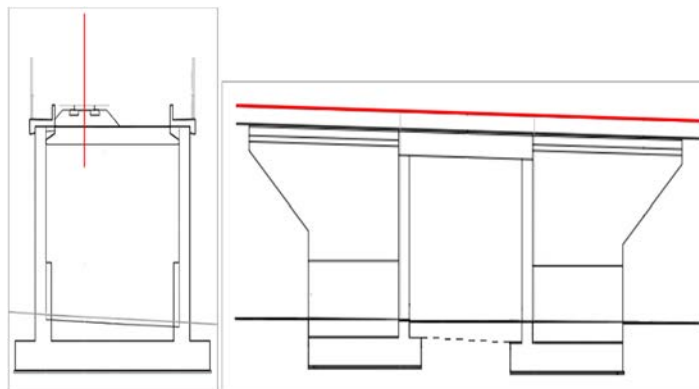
Coupe transversale et longitudinale du pont-rail.
